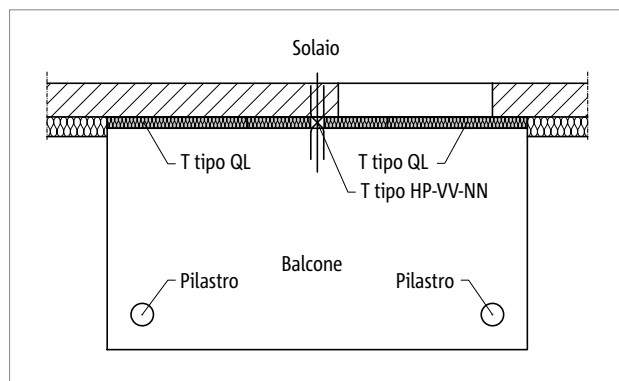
Schöck Isokorb® T tipo HP: balcone con appoggio su pilastri
